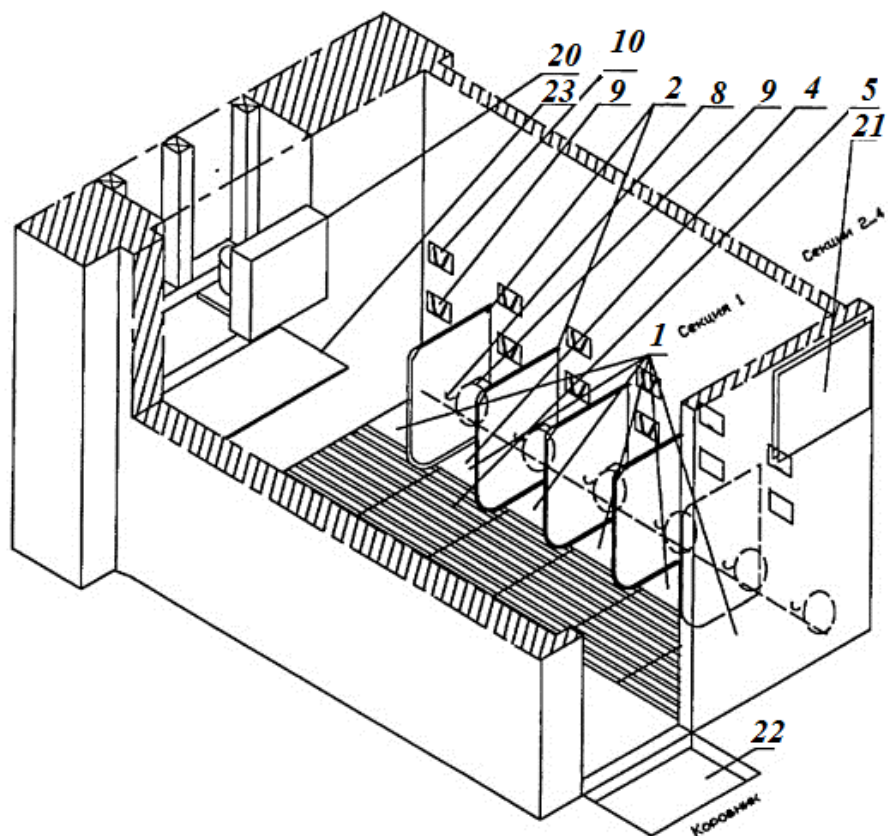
Профилакторий для содержания телят: 1 – полубокс; 2 – перегородка; 3 – часть стены; 4 – сплошной пол; 5 – решетчатый пол; 8 – ведродержатель; 9, 10 – кронштейны; 20 – компрессорно-конденсаторный агрегат; 21 – испаритель; 22 – дезинфекционный мат
